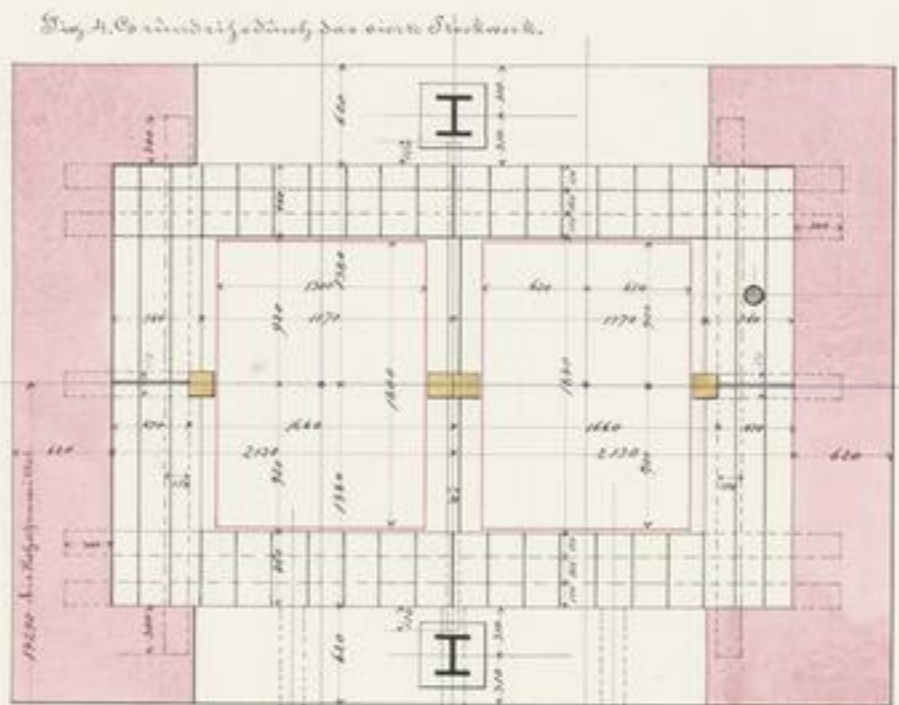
Grundriss durch das alte Streckwerk.
